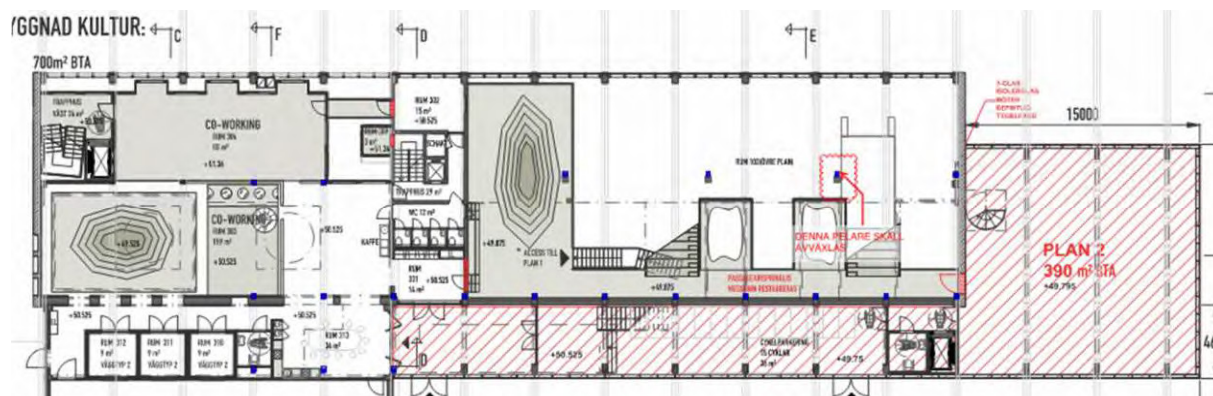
Plan 2, nya pelare markerade i blått. Här framgår hur pelare hamnar över befintliga betongväggar samt intill befintliga pelare till befintlig entresol.
